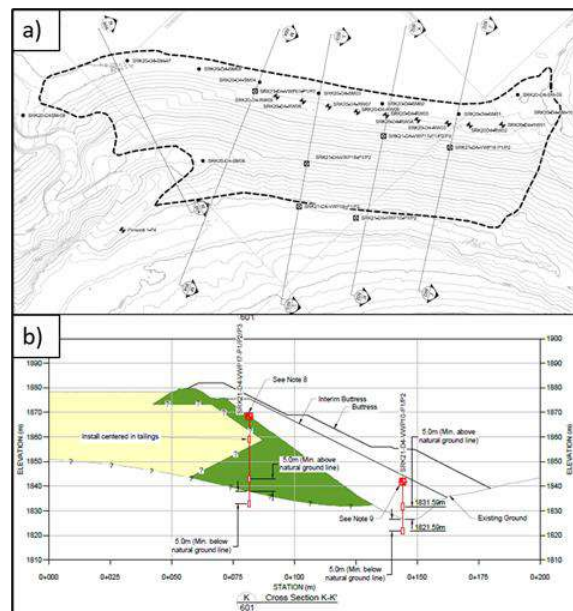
Mina en San Luis Potosí: (a) vista en planta y (b) elevación en bordo principal. Vista en planta del TSF4
